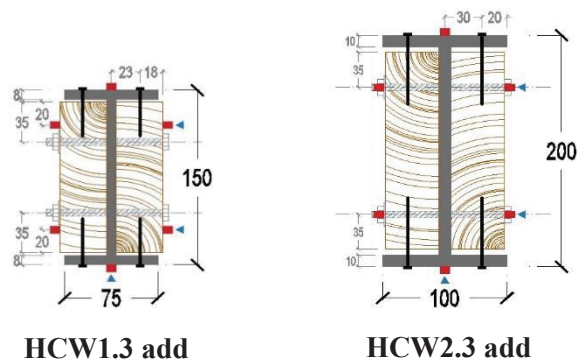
sections des poutres hybrides avec vis additionnelles
